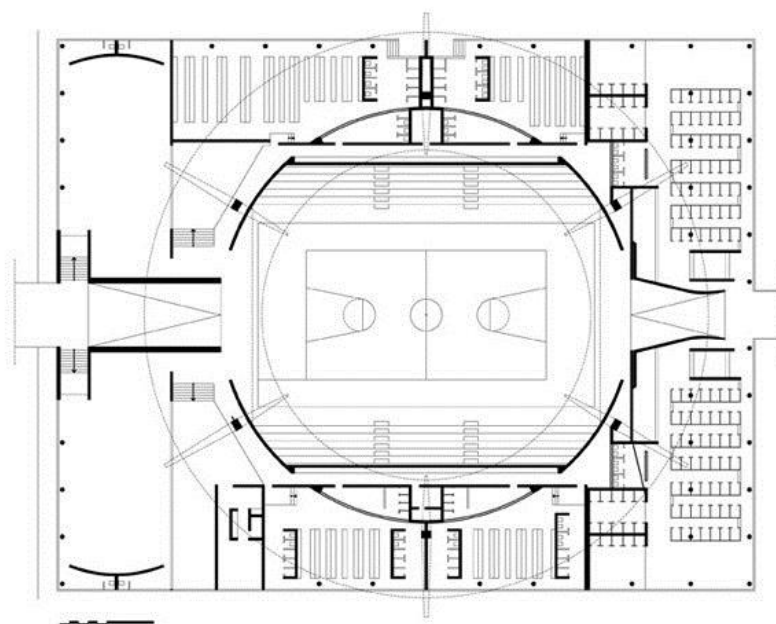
Planta baixa do Ginásio (Fonte: ARTIGAS, 2000)
